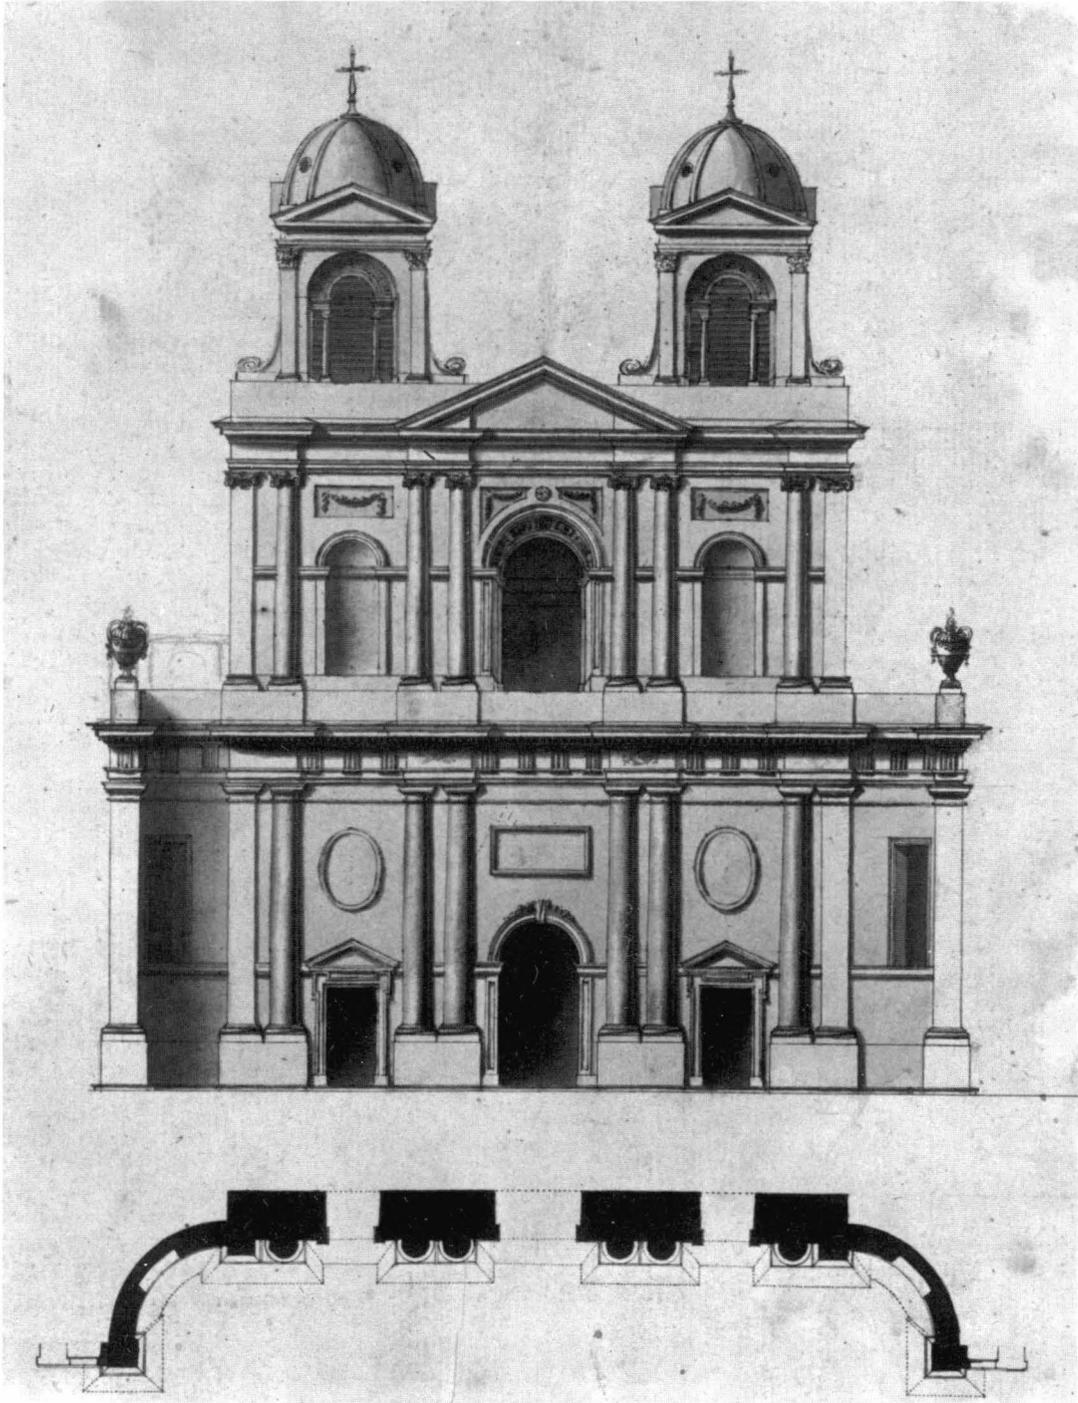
Élévation de la façade de l'abbatiale de Villers dessinée par Dewez
